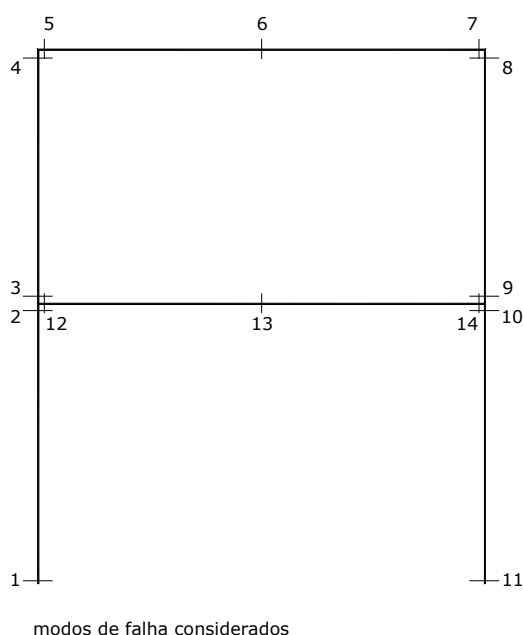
Geometria e dimensões da estrutura analisada
